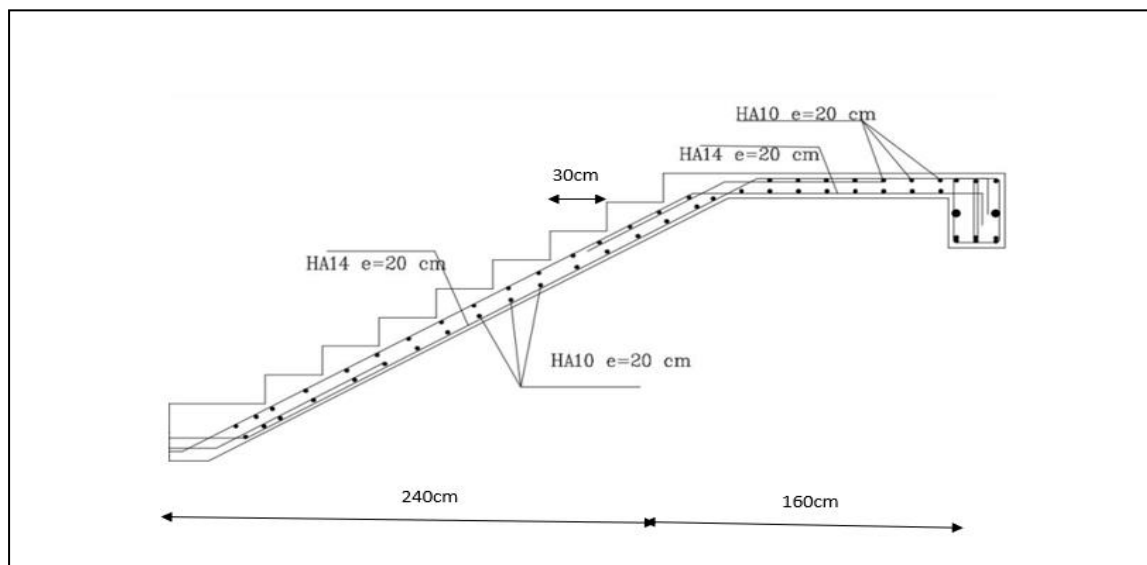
Schéma ferrailage de l'escalier (paillasse2 et 3)
